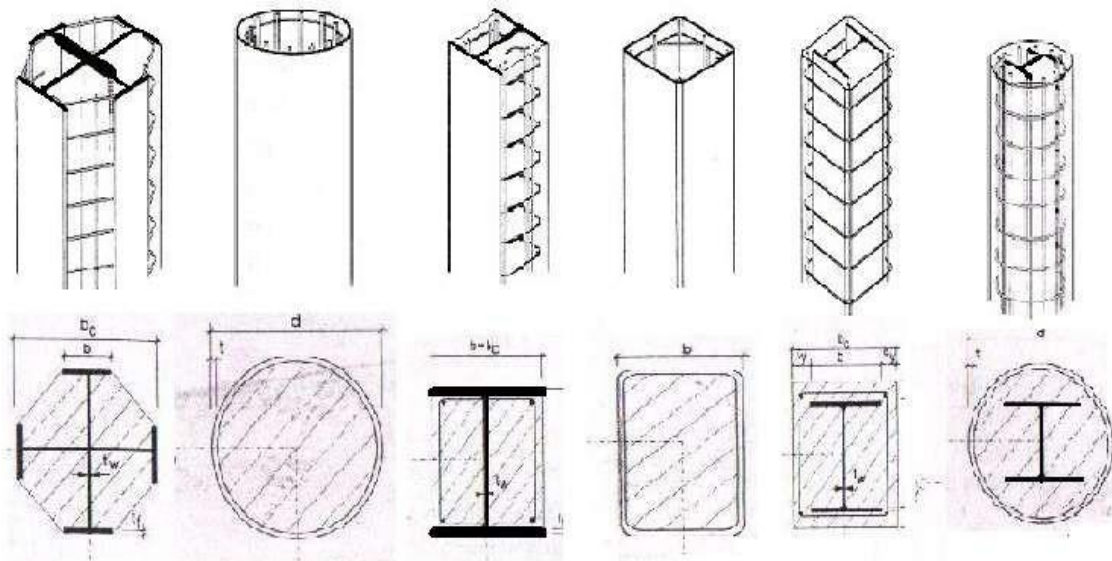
Exemples de sections transversales de poteaux mixtes
